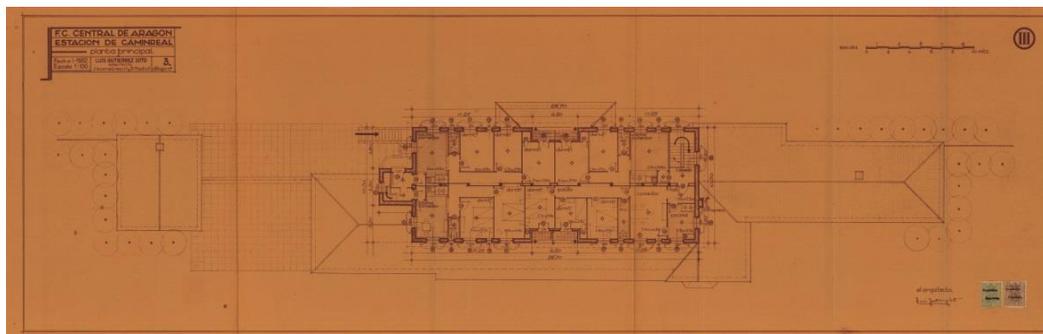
Planta Alta de la estación de Caminreal. Plano de proyecto. (Fuente: Archivo AHF, 1932)
